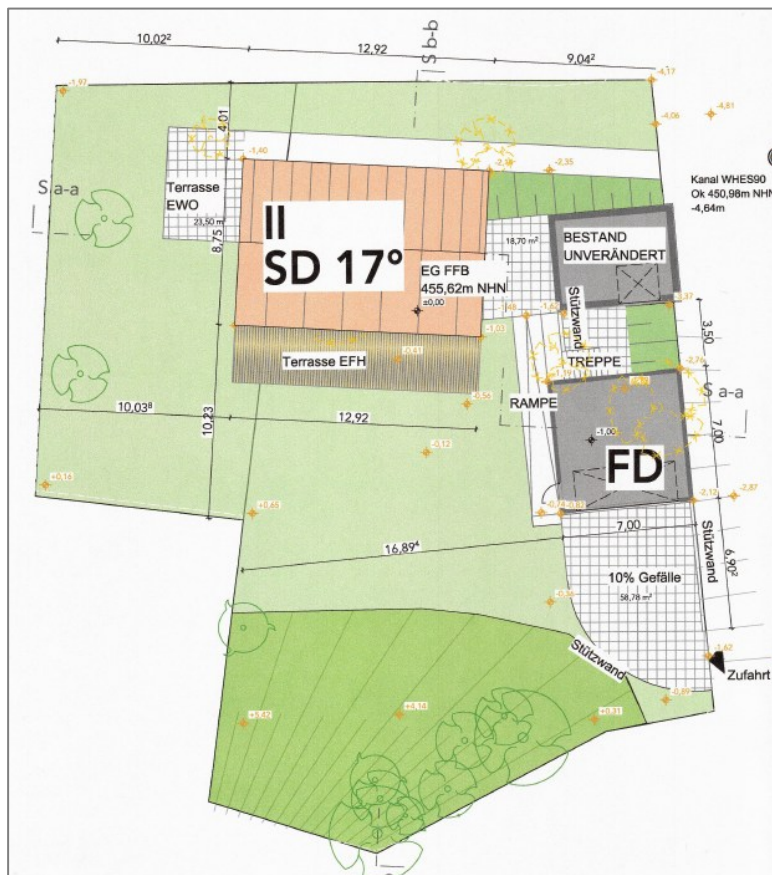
Lageplan (Planungsbüro arpla, Stand 02.08.2024)
